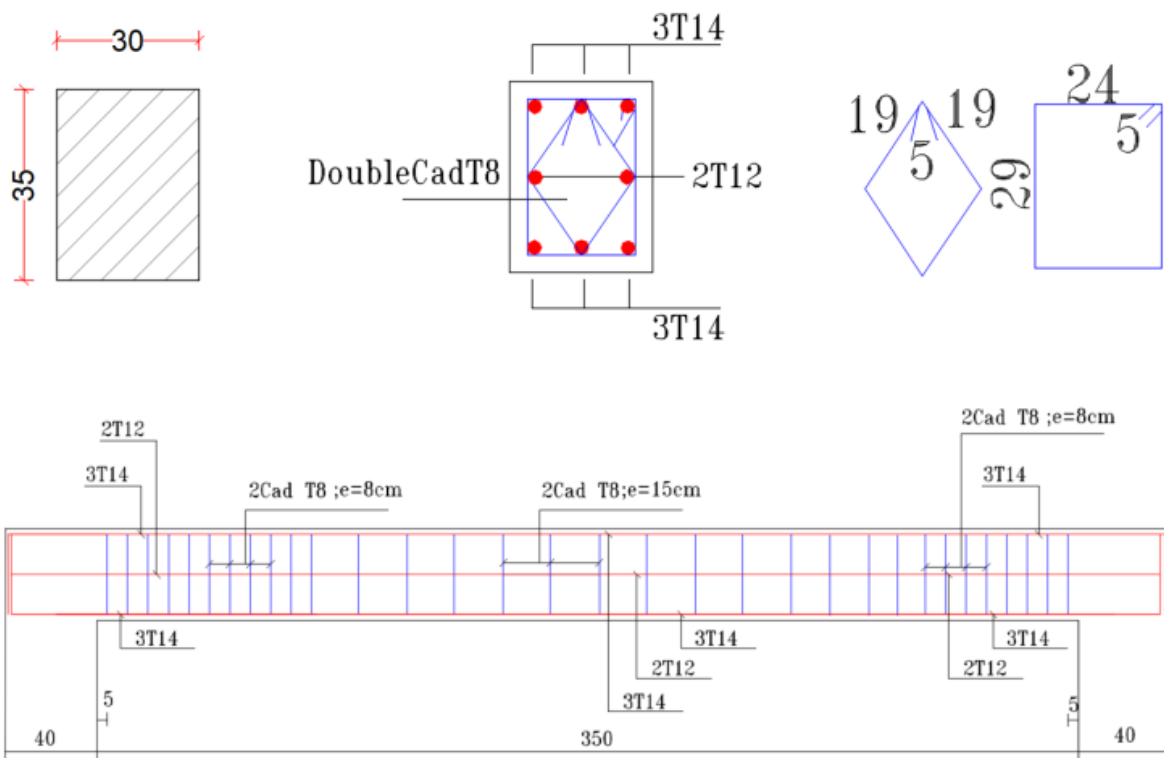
Schéma de ferrailage de la poutre palière
